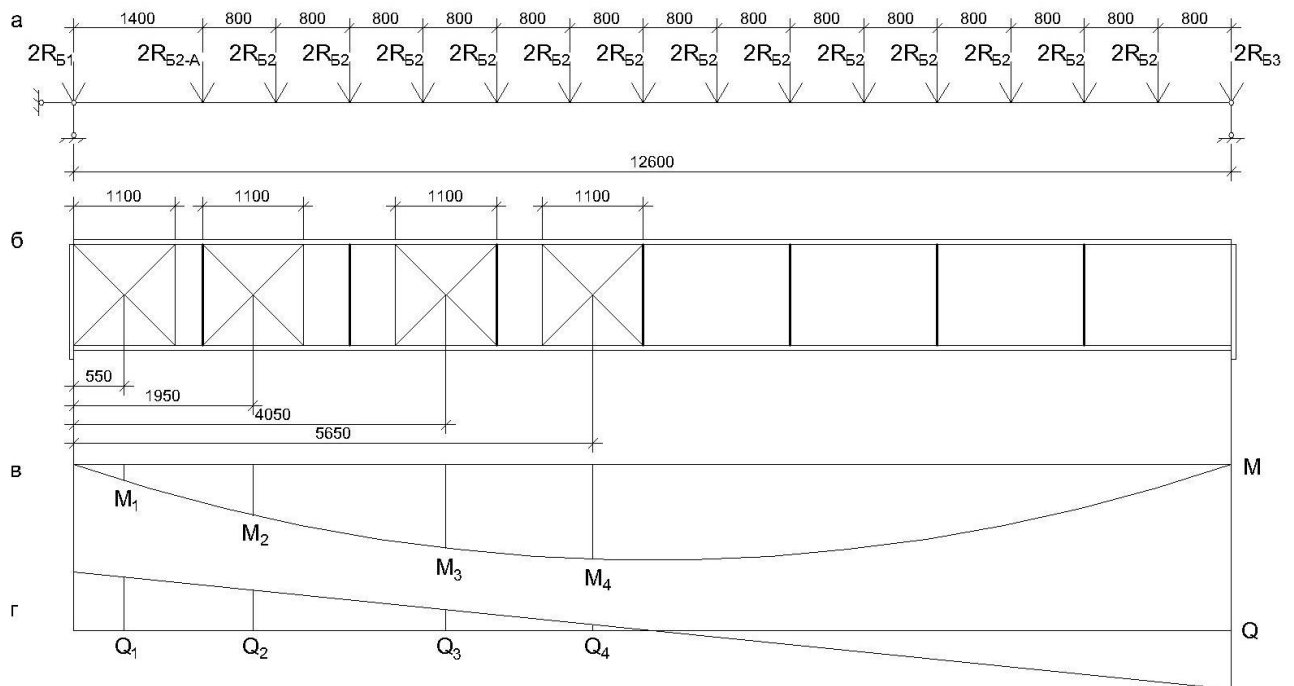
Проверка местной устойчивости стенки главной балки Г2: а - расчётная схема балки, б - расположение расчётных отсеков, в - эпюра изгибающих моментов, г - эпюра поперечных сил
